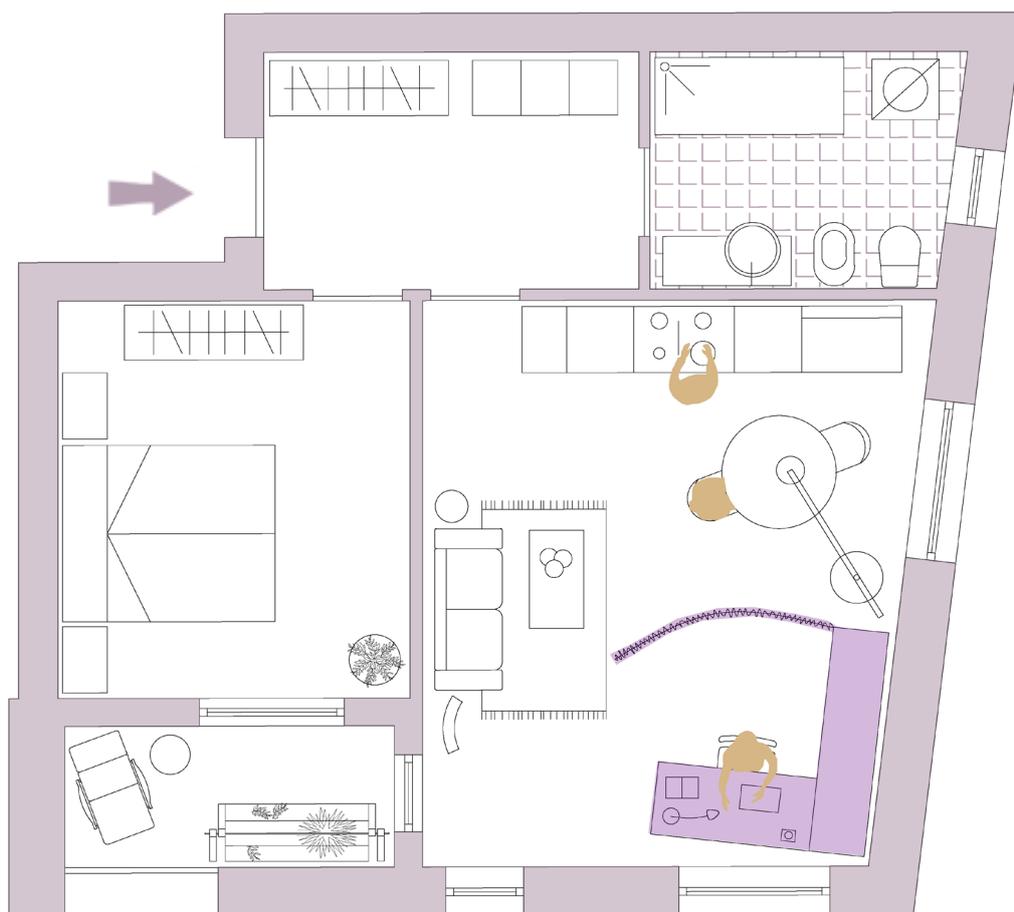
Rappresentazione planimetrica soluzione ambiente studio / lavoro.
